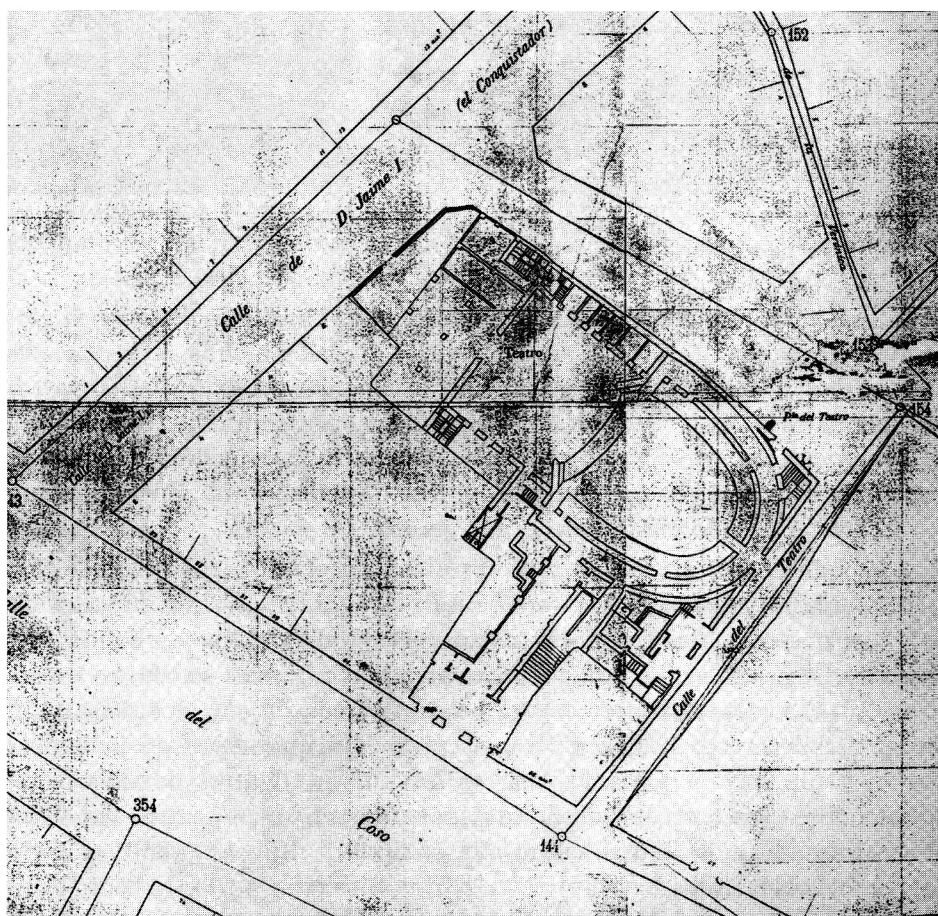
Planta del Teatro Principal en 1879 (AMZ).
